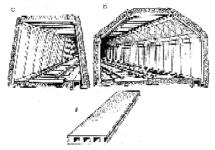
Виробки, закріплені конструкціями з універсальних плоских плит:
